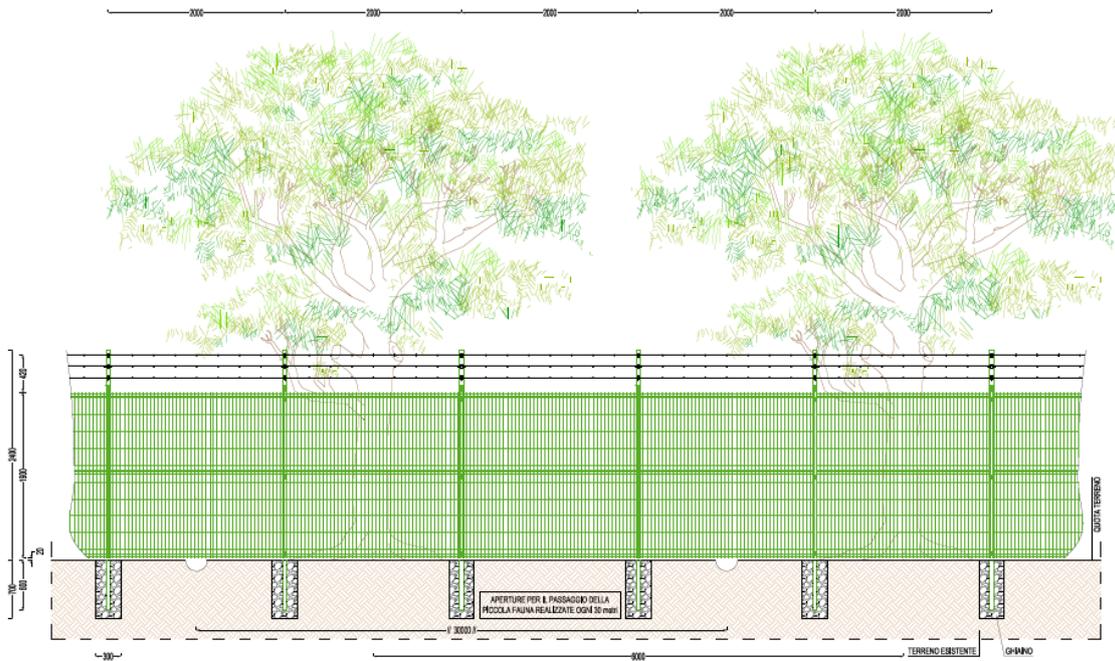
Prospetto recinzione con fascia di mitigazione
